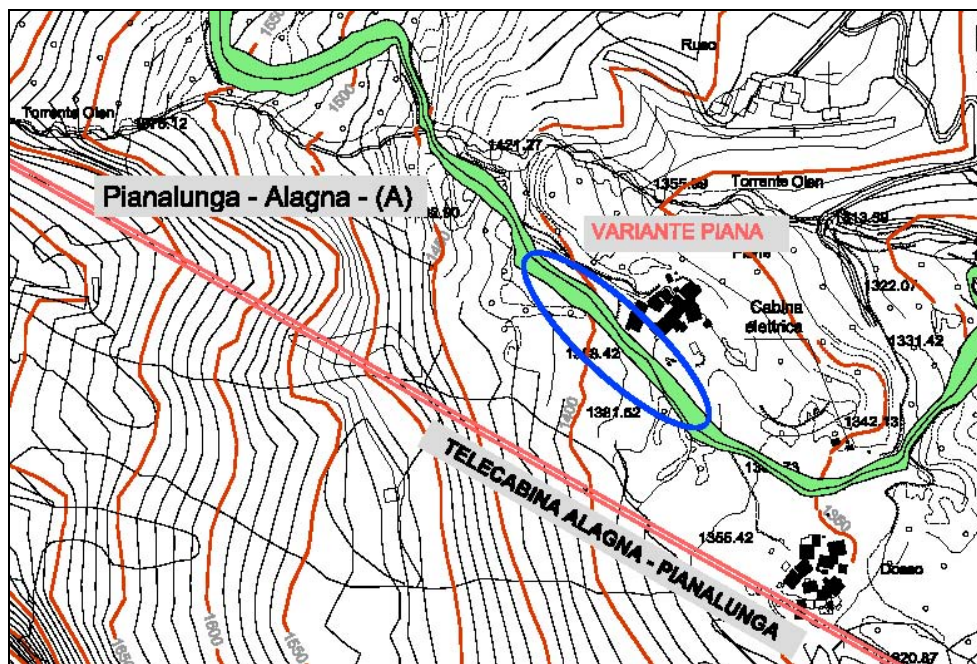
/1 Tratto soggetto a variante della pista Pianalunga – Alagna
